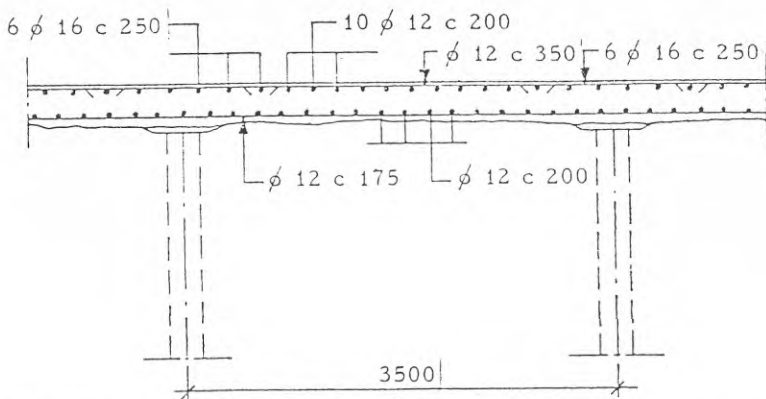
Sektion genom pålad betongplatta under vändplan.
